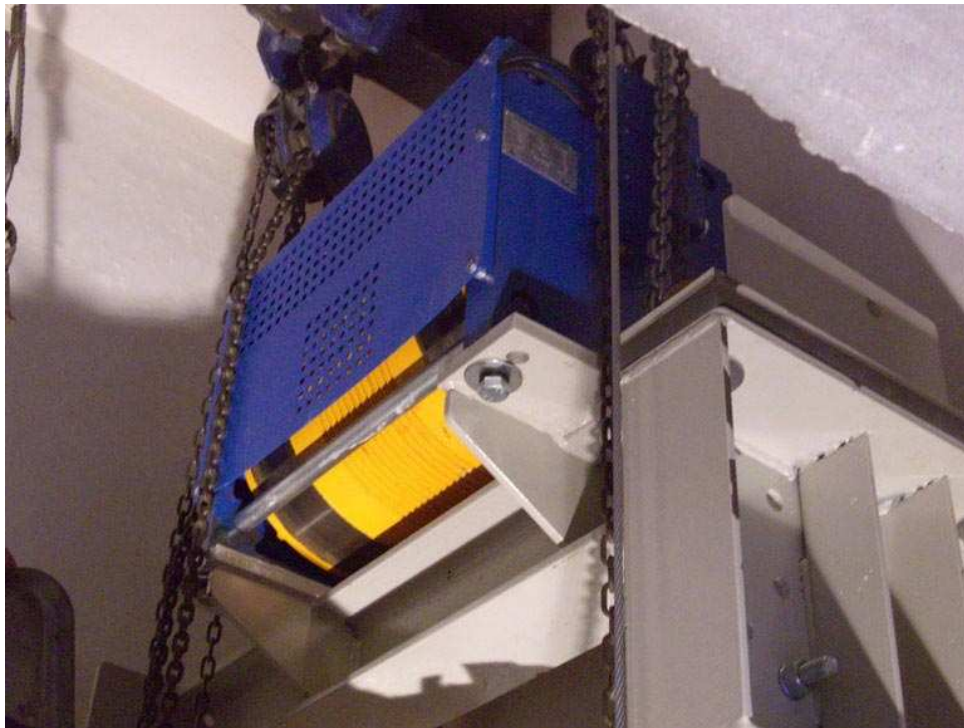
Máquina Gearless instalada en lo alto del hueco del ascensor (Fuente: COMAQ)
